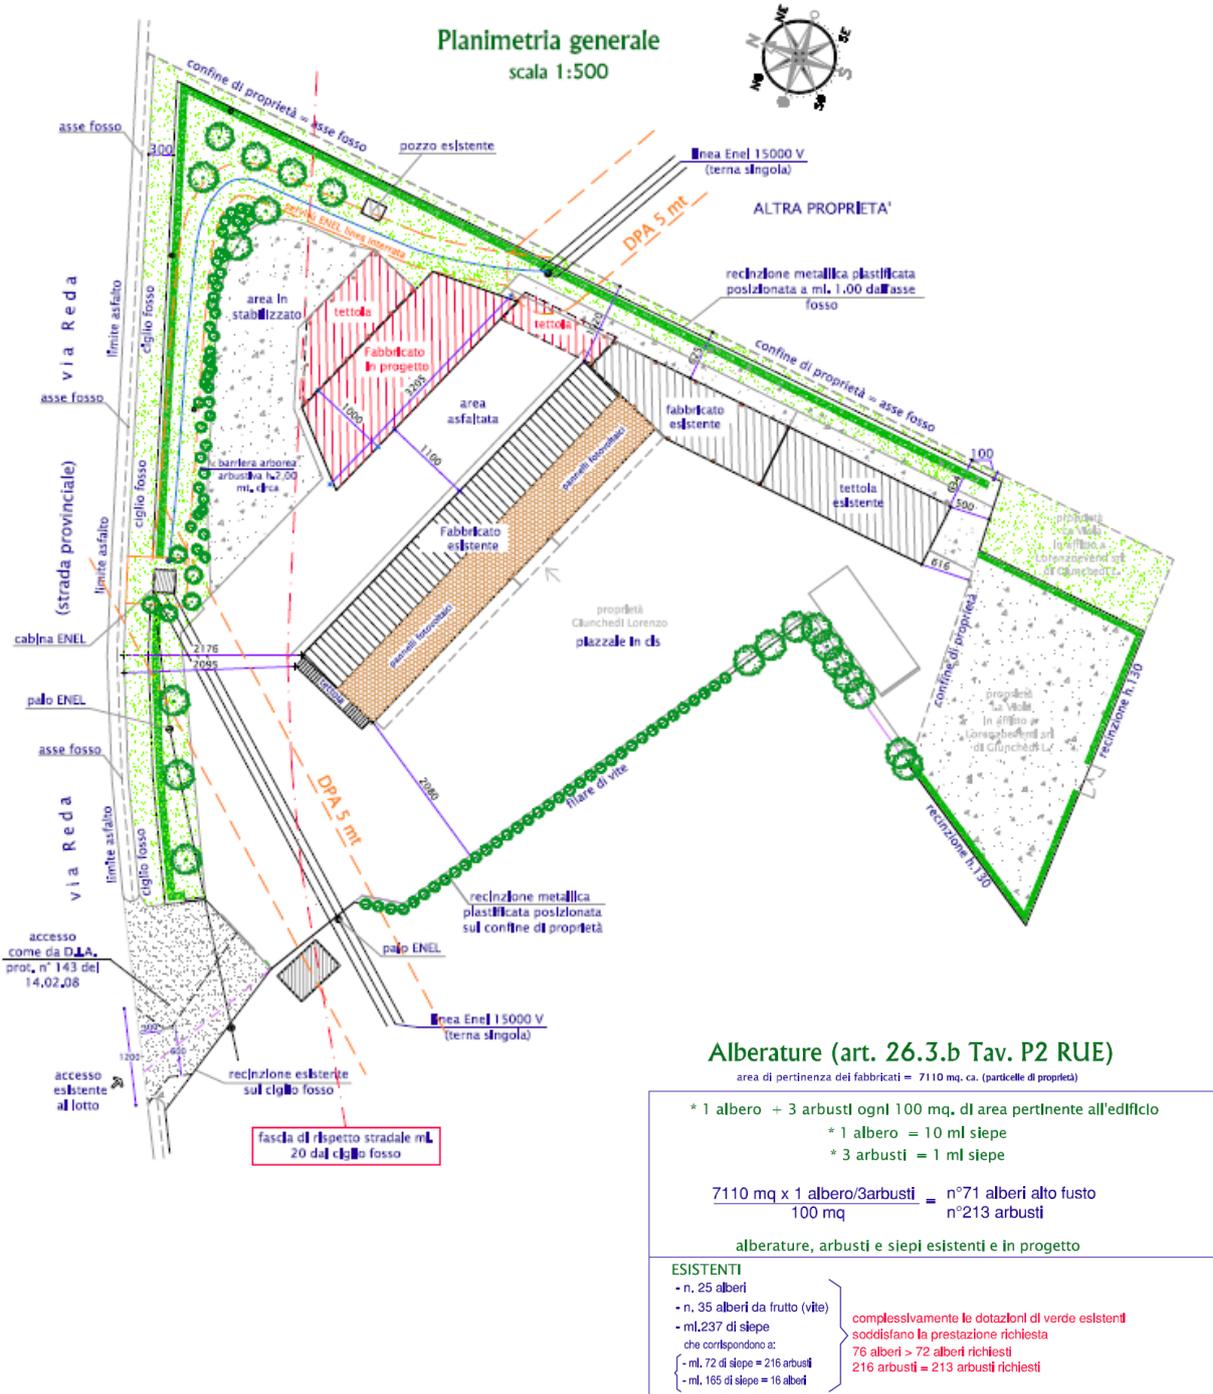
Estratto Tavola 2 - Stato modificato - Planimetria generale
